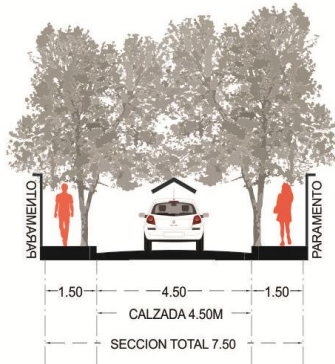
Sección Mínima con banqueta mínima.
